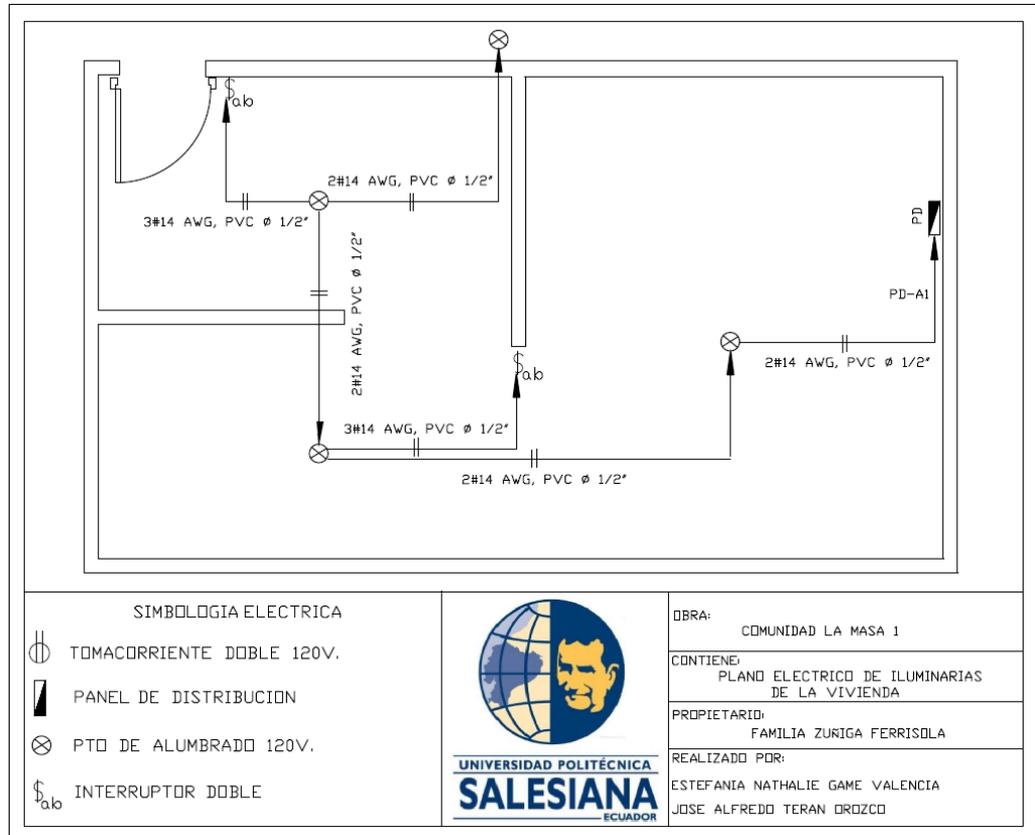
Plano eléctrico de iluminarias de la vivienda (Fuente: Autores).
